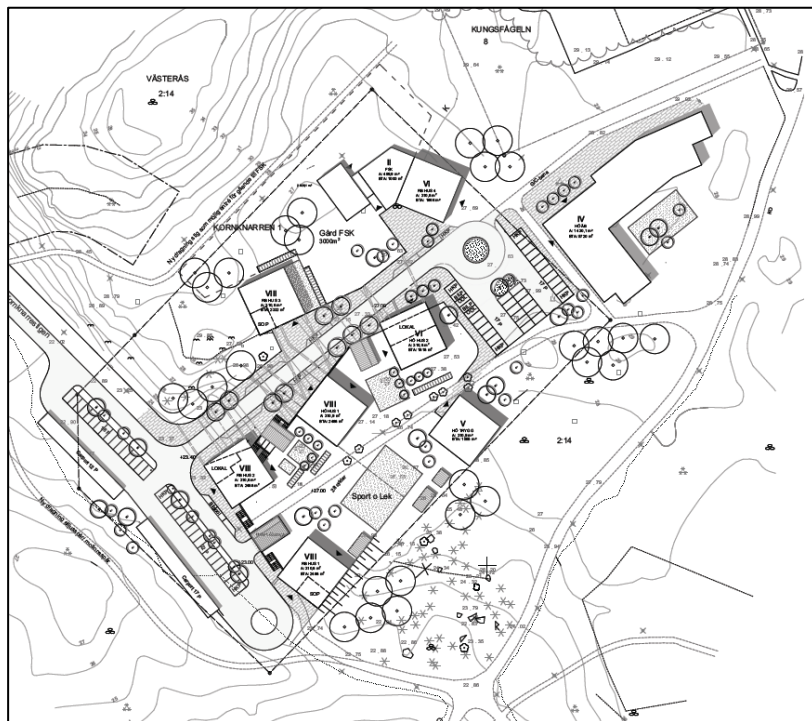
Planerad bebyggelse, Tovatt Architects and Planners AB, 2017-03-24
